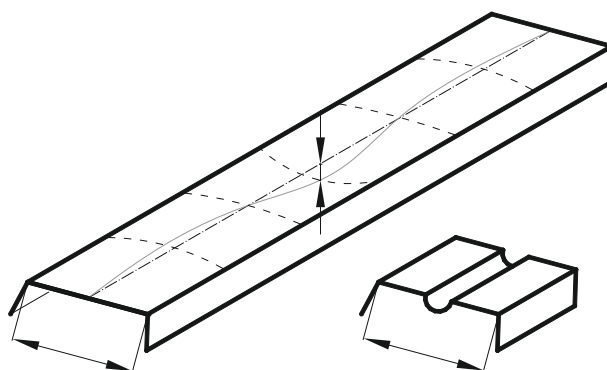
Planéité des plages/sommets ou âmes raidis ou non raidis
